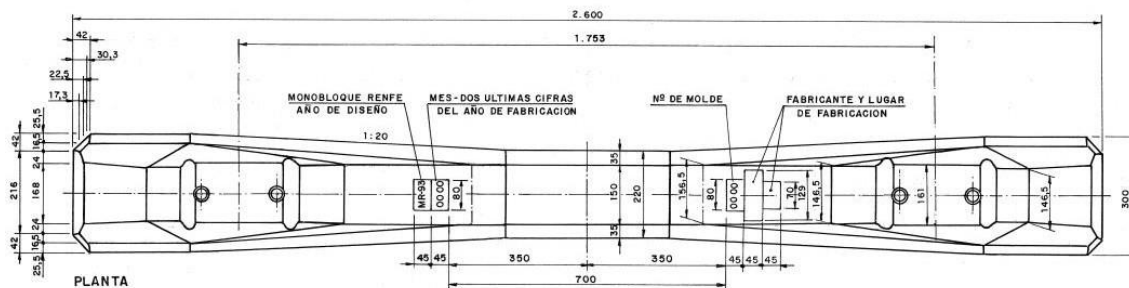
Planta Traviesa MR-93 (Fuente: ADIF)
